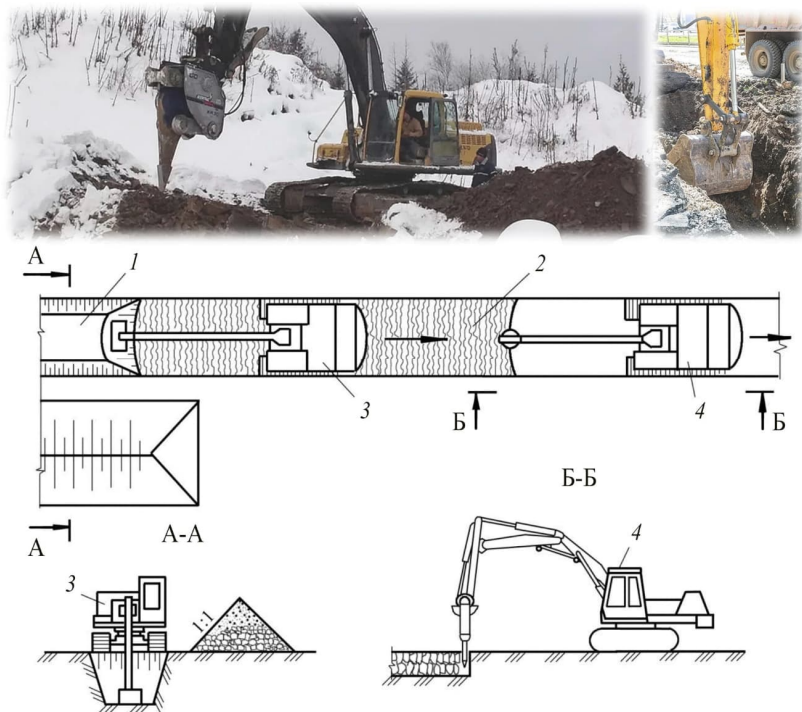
Розробка траншеї з розпушенням мерзлого ґрунту гідромолотом: 1 – траншея; 2 – зона розпушеного ґрунту; 3 – екскаватор з ковшем; 4 – екскаватор з гідромолотом
